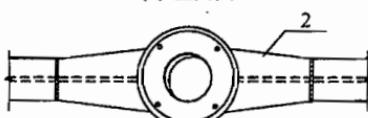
等截面悬臂钢梁与钢管混凝土柱采用内加强环连接构造示意
